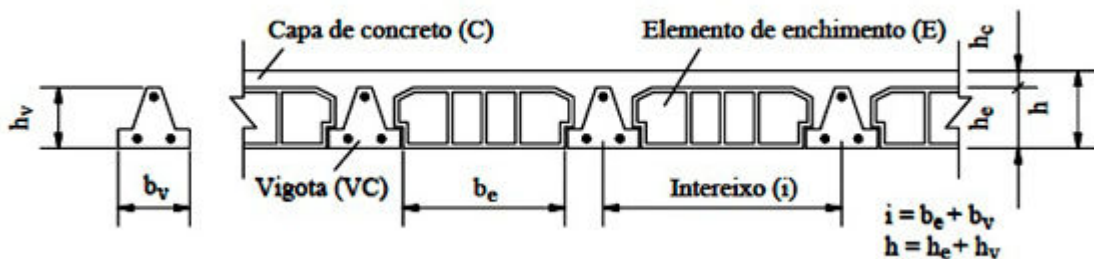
Seção transversal de uma laje com vigotas de concreto armado
